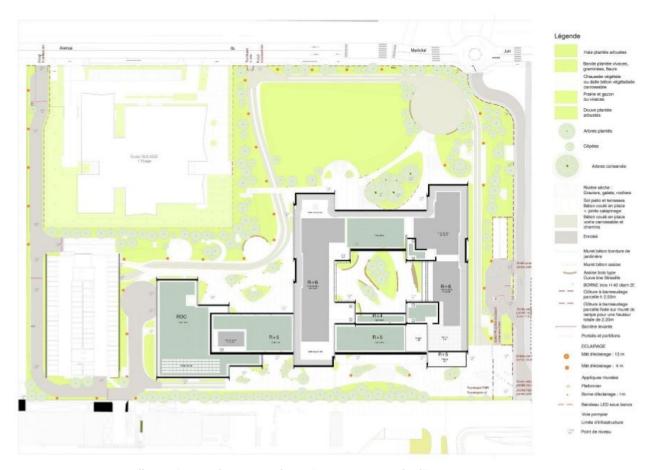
plan masse du projet, source : étude d'impact, p. 204
